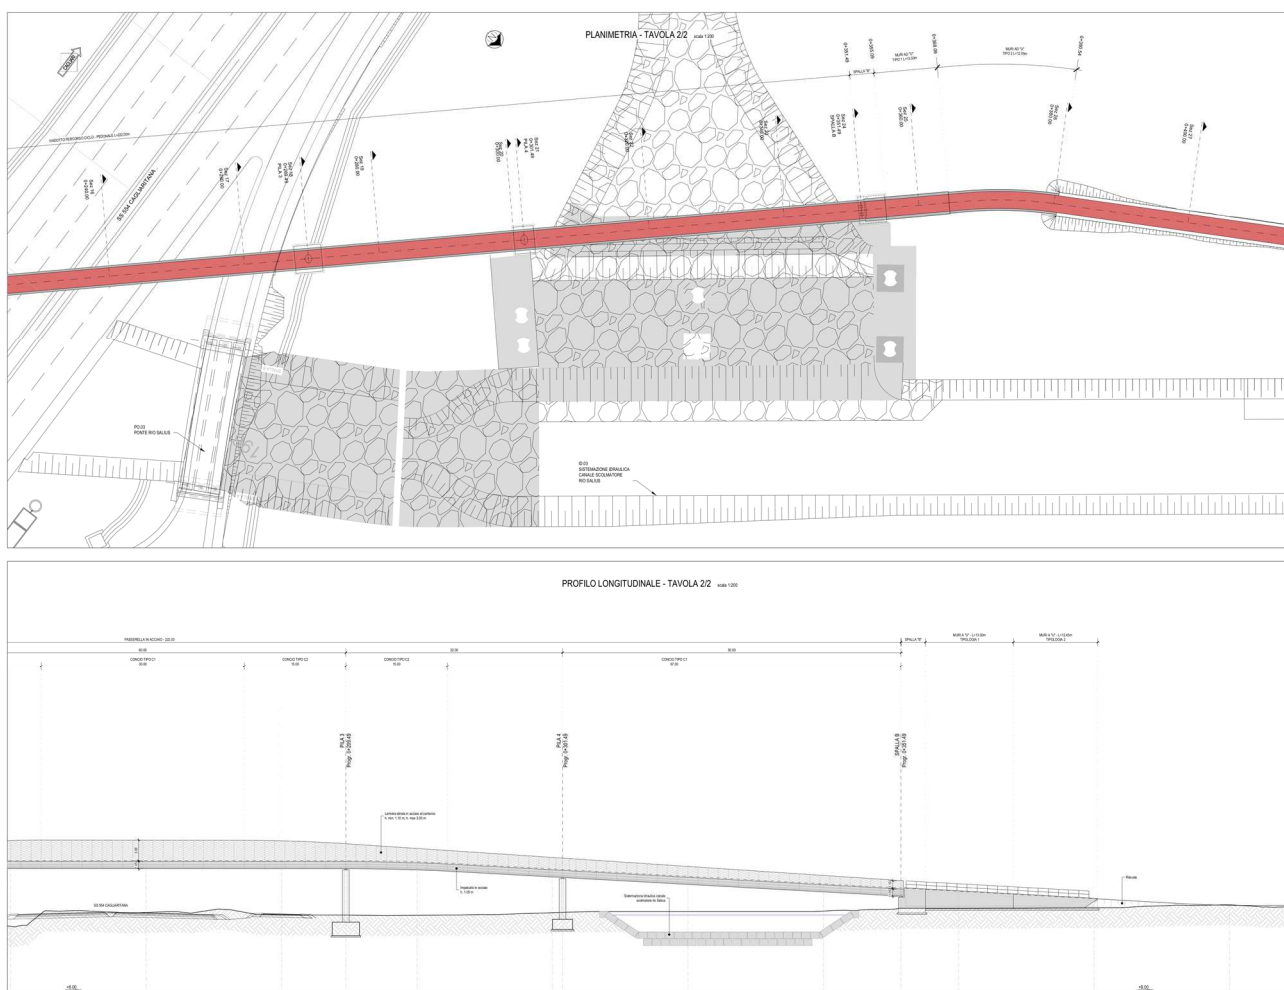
Pianta e prospetto del ponte (2 di 2)
